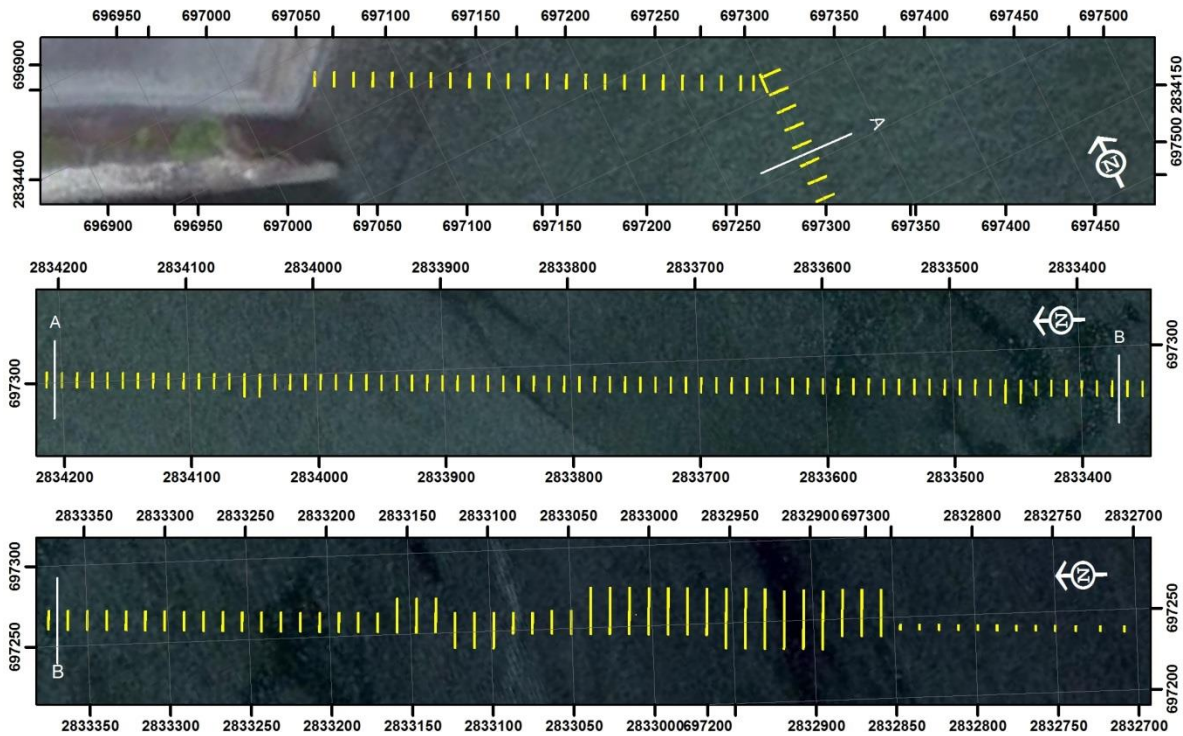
Ubicación de las estructuras de soporte de la terminal portuaria.
